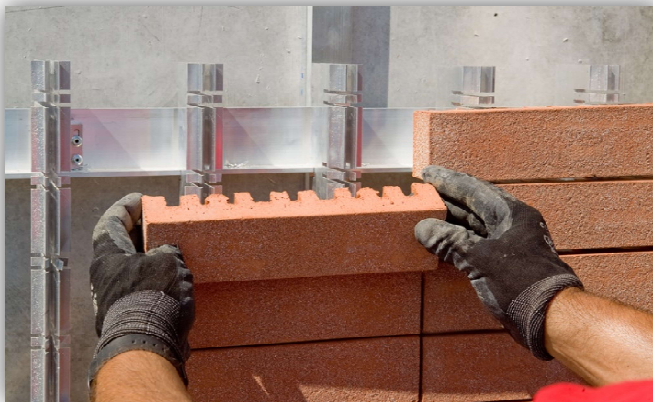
Instalación de fachaleta con cuatro guías posteriores tomado de: <http://www.terremilia.com/Sezione.jsp?idSezione=164>
